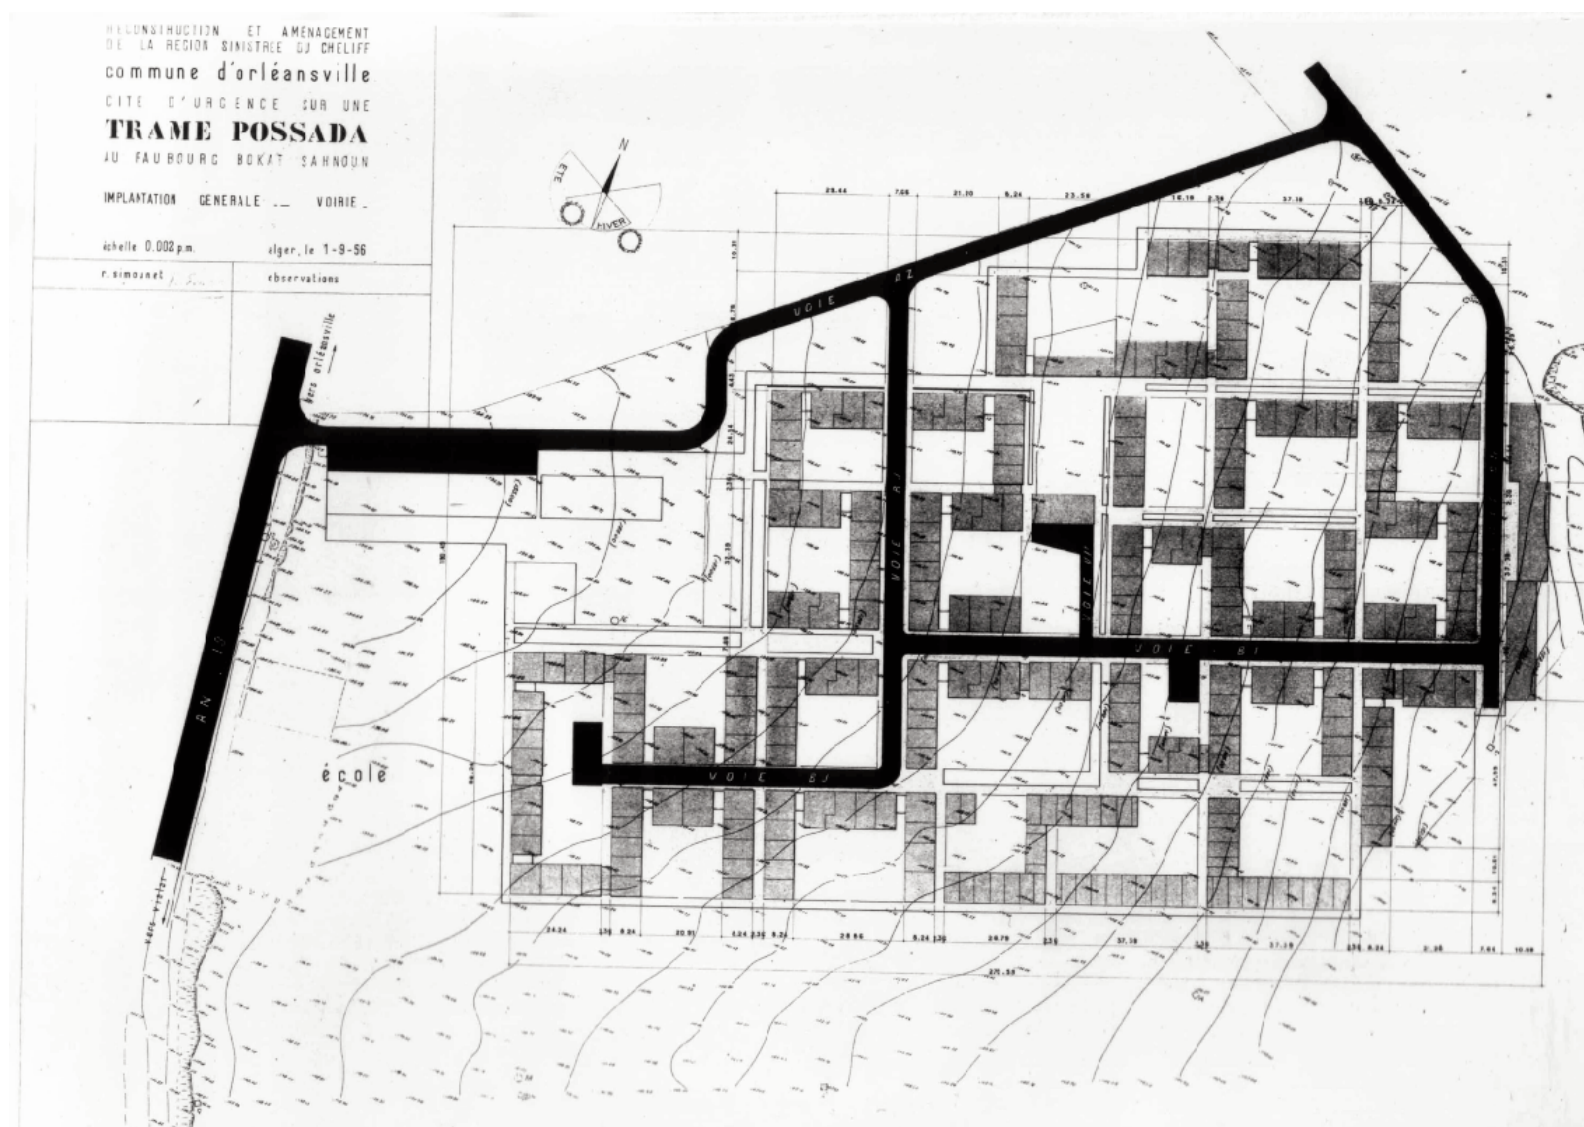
Roland Simounet, cité di rialloggiamento detta Trame Possada a Orléansville, 1955-1956 (non realizzata): planimetria.
